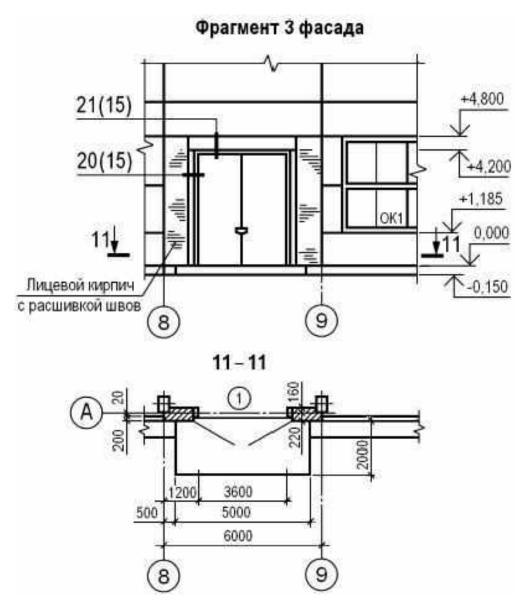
Пример выполнения примера фасада промышленного здания
